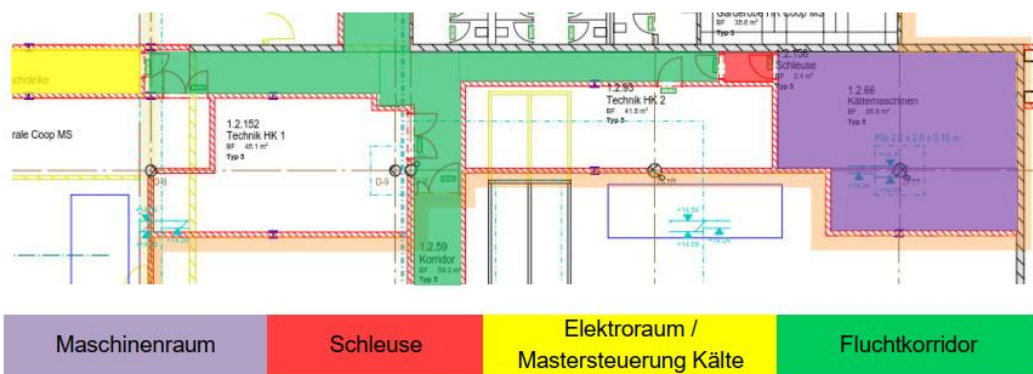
Grundriss/Zonen Kältezentrale
